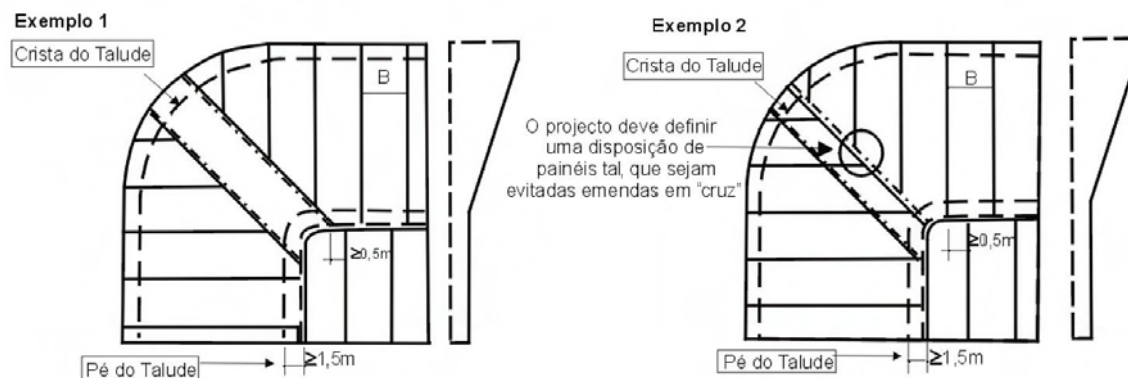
Disposição de painéis com comprimento superior a 15m (Barroso & Lopes, 2008).
